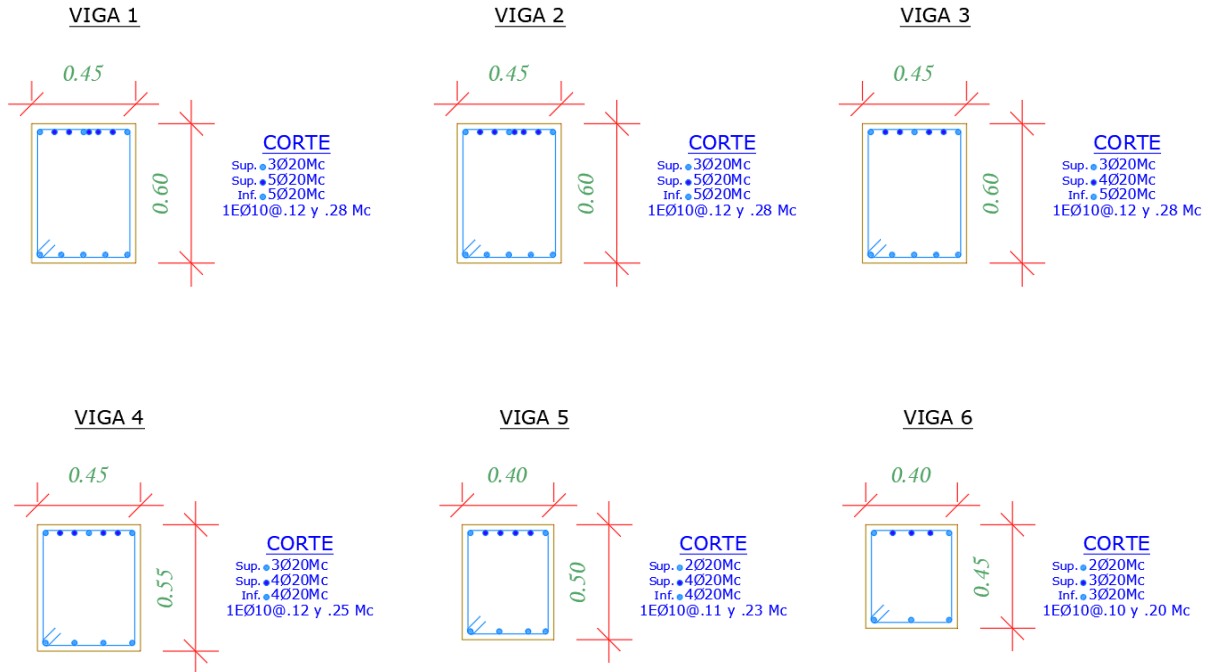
Secciones transversales de las vigas utilizadas en un edificio de 6 pisos
